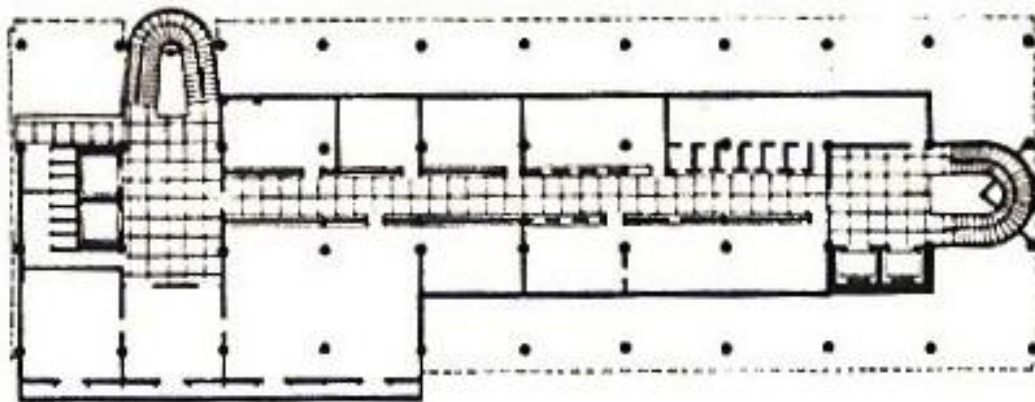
Grundriss des 2. Geschosses, Büros.
